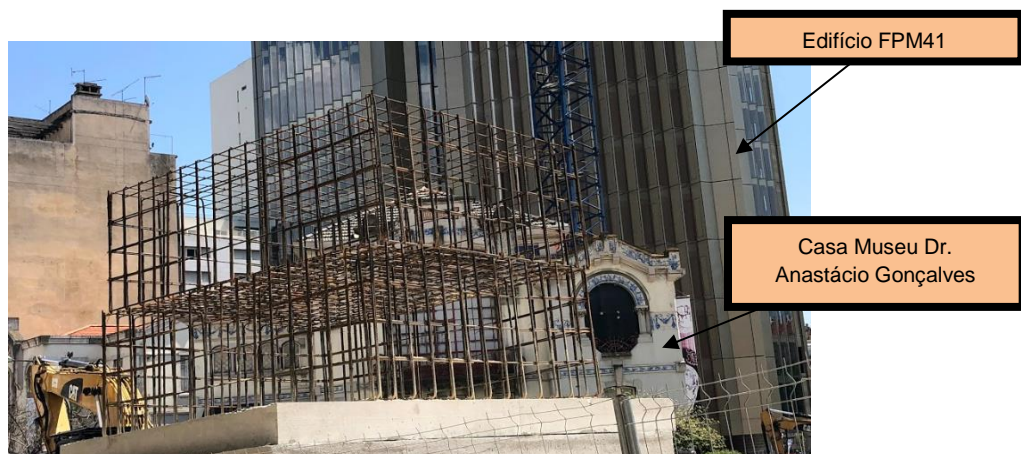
(obtida no local da obra a 7 de maio de 2018): Pormenor das armaduras das sapatas dos pilares
